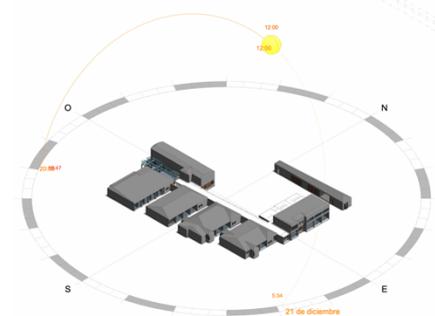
Modelo D Fuente: Elaboración propia a partir de planimetría obtenida en DOM.
